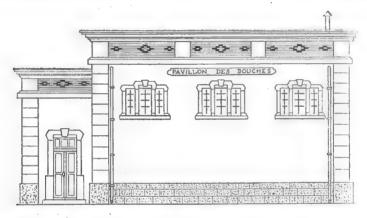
Façade du Pavillon des bains-douches à cabines individuelles.
